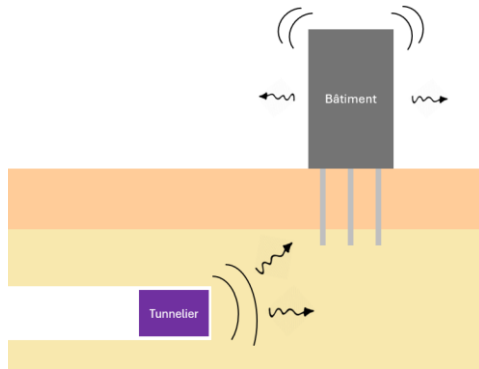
Schéma de principe des vibrations générées par l'excavation d'un tunnel au tunnelier et de leur impact sur les bâtiments en surface
